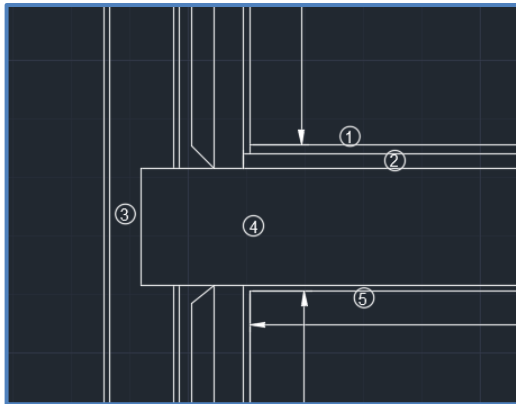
Elementos del forjado y unión con la fachada. Supuesto 1 (Fuente propia)
